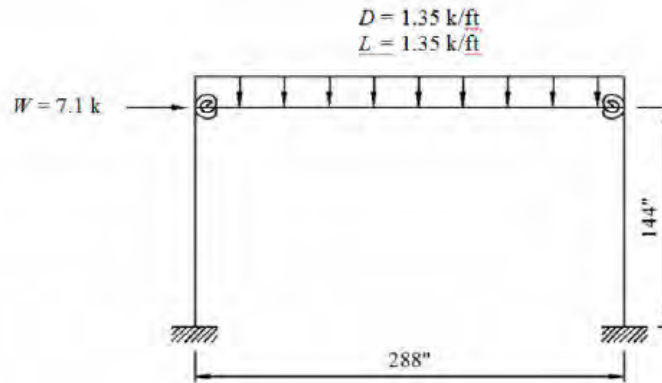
Pórtico plano de acero con conexiones Semi-rígidas..
